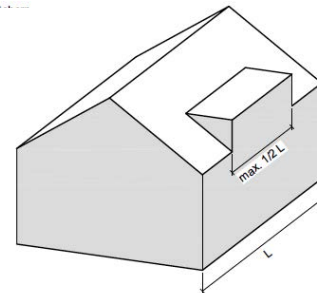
schematische Darstellung Dachaufbauten gemäss neuPBG (1/2 der Fassadenlänge)
